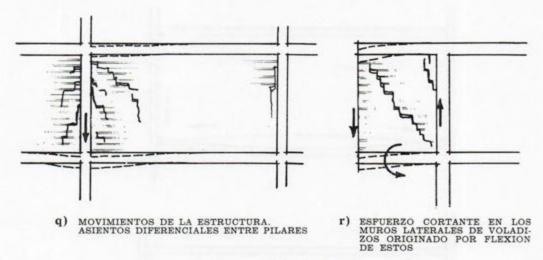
FISURAS EN LOS MUROS DE OBRA DE FABRICA
